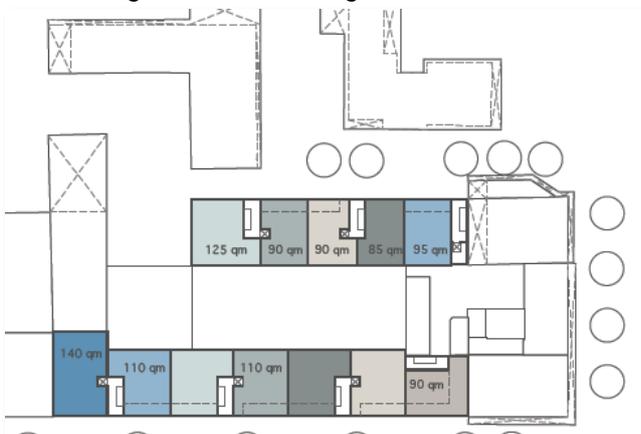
Grundriss 2. Obergeschoss
